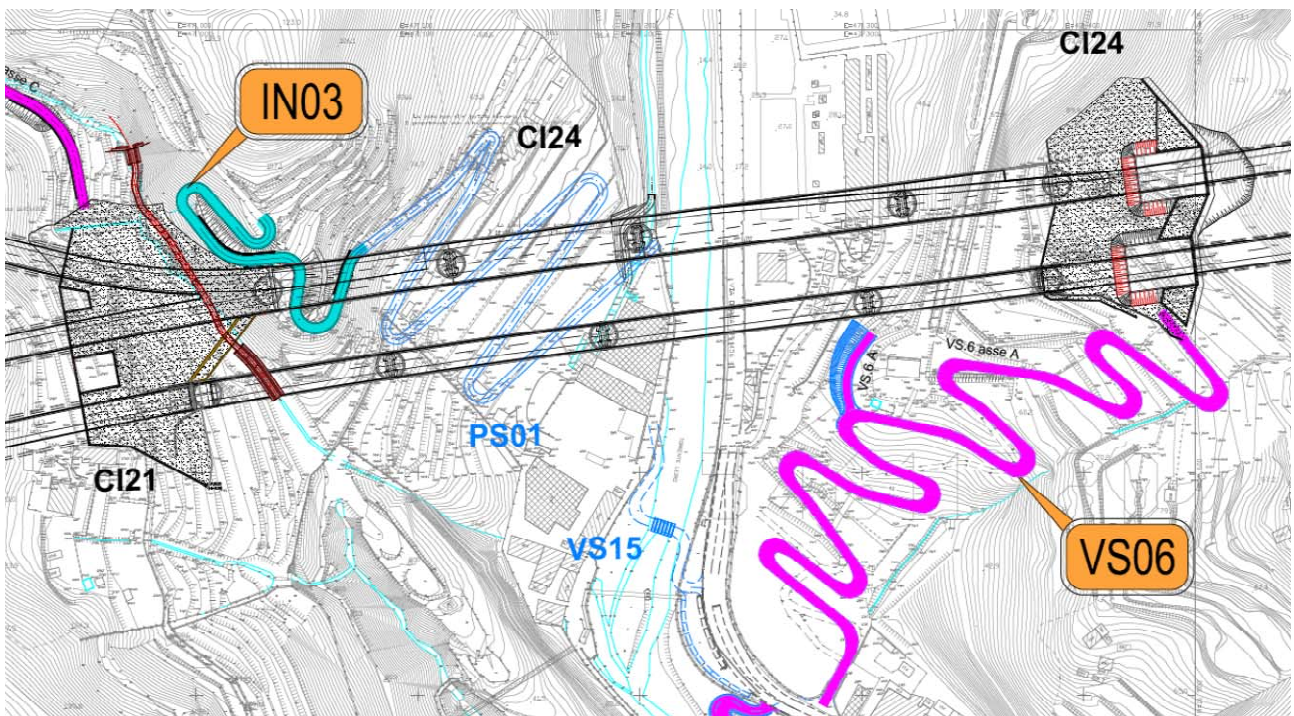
Viabilità di servizio – Stralcio area val Leiro (cfr. elaborato STD1011)
